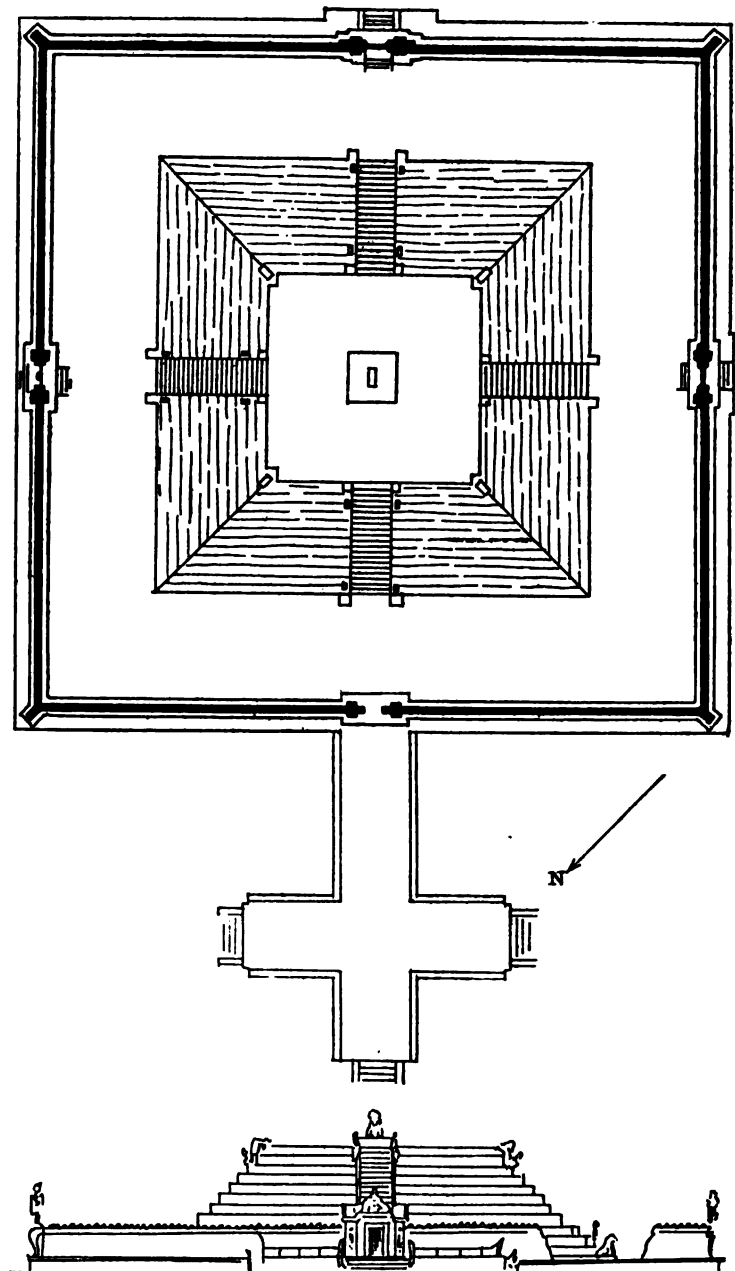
Prah Damrei, n° 177. Plan et croquis de façade restaurée. [H. P.]
